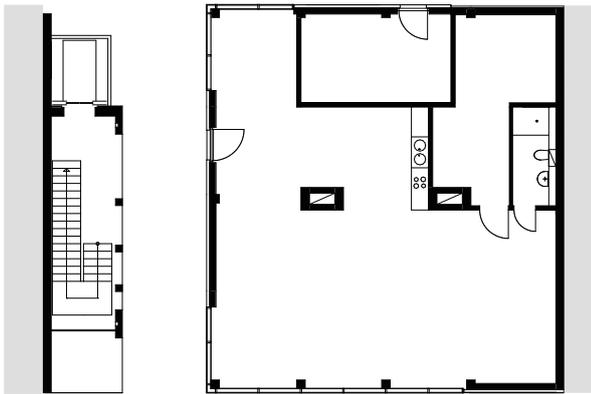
E3 Wohnhaus, Erdgeschoss
